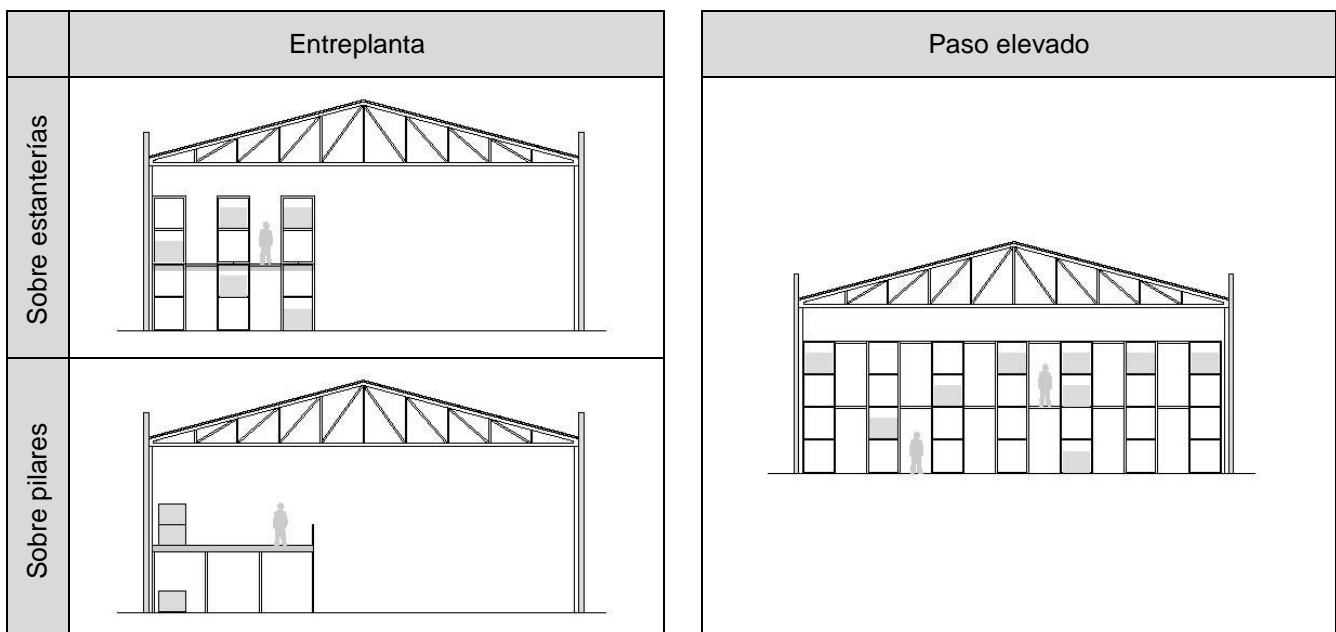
Clasificación de los pasos elevados y entreplantas
